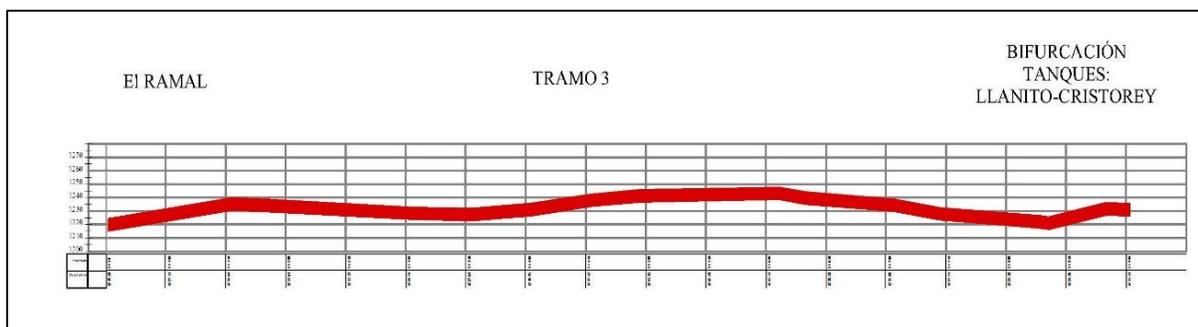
Perfil del terreno tramo El Ramal hasta la bifurcación denominado San Cayetano. Fuente: Pasante del proyecto.
